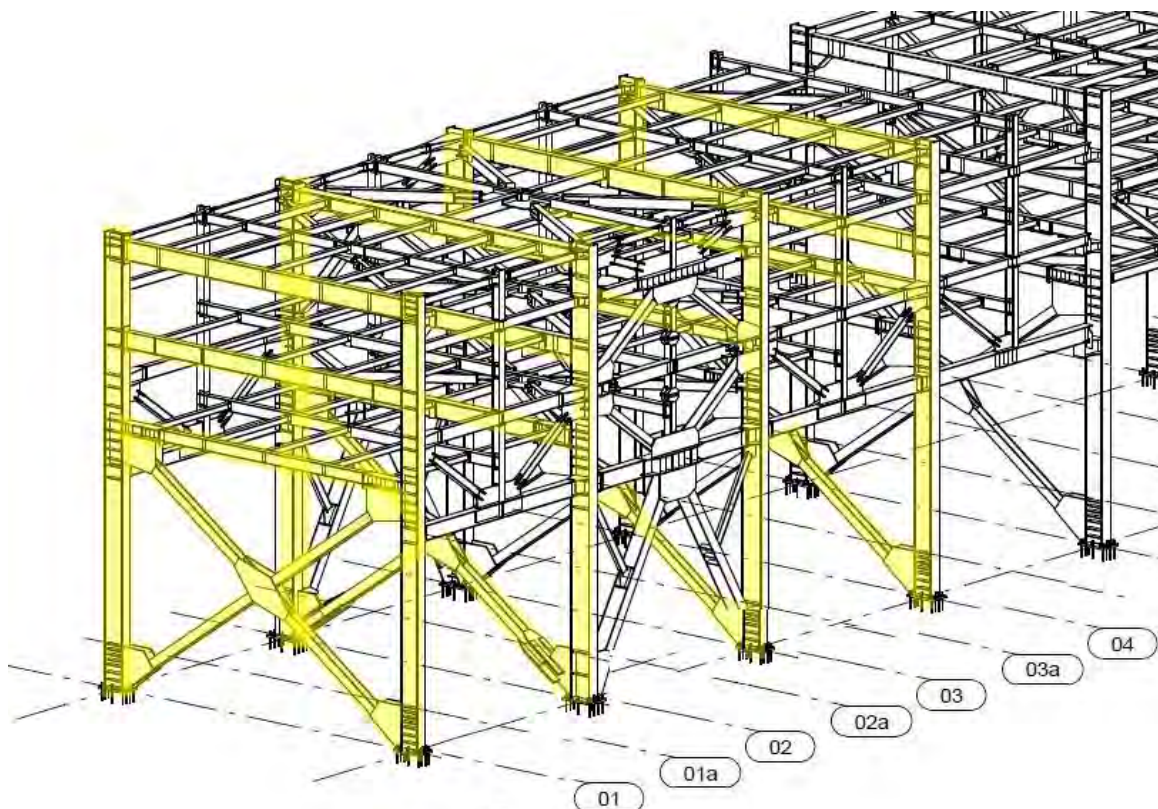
Vista de la secuencia de montaje de pre-ensamblados (pórticos)
